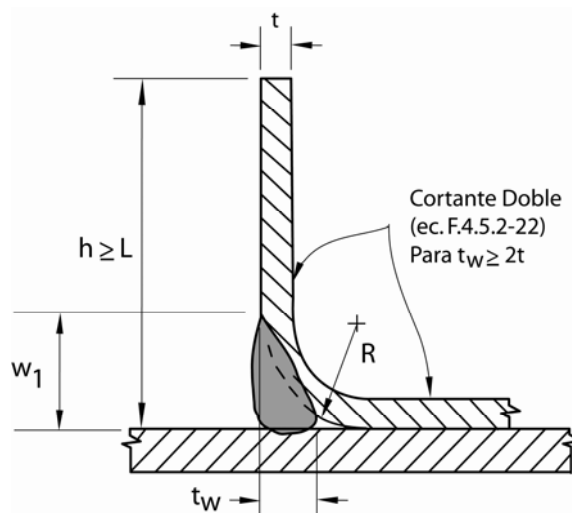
Soldadura abocinada en media V (Llenado a ras de superficie, $w_1 = R$)
